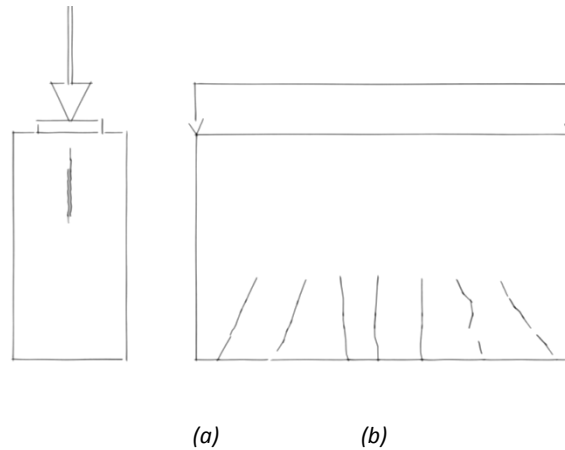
(a) fisuración concentrada (b) fisuración distribuida
